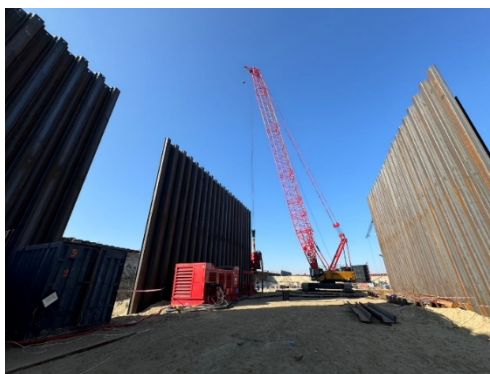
Монтаж шпунтовых стенок шлюза Багаевского гидроузла
